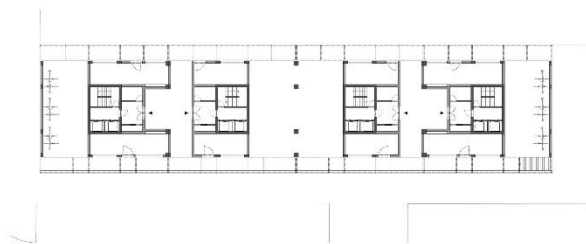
Planta do Plan Tórres do Edifício 2 e 9
